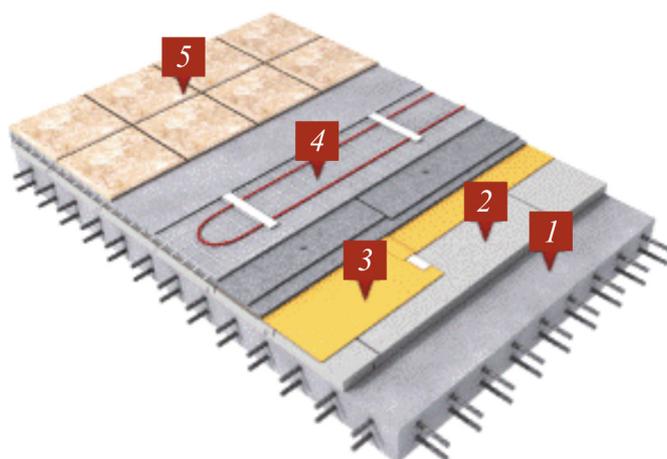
Система «теплый пол»: 1 – железобетонная плита перекрытия; 2 – экструдированный пенополистирол; 3 – полиэтиленовая пленка; 4 – цементно-песчаная стяжка с нагревательными элементами; 5 – плитка, покрытие пола
